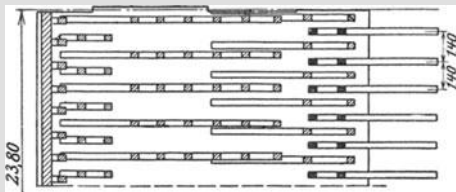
e. Grundriß durch die Schleusenmauer. Maßstab 1:380.
